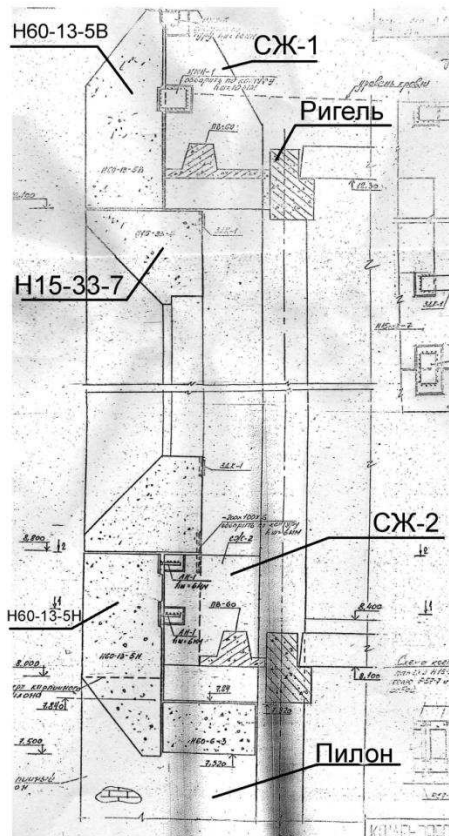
Схема размещения конструкций устроенных между СЖ-1 и СЖ-2
